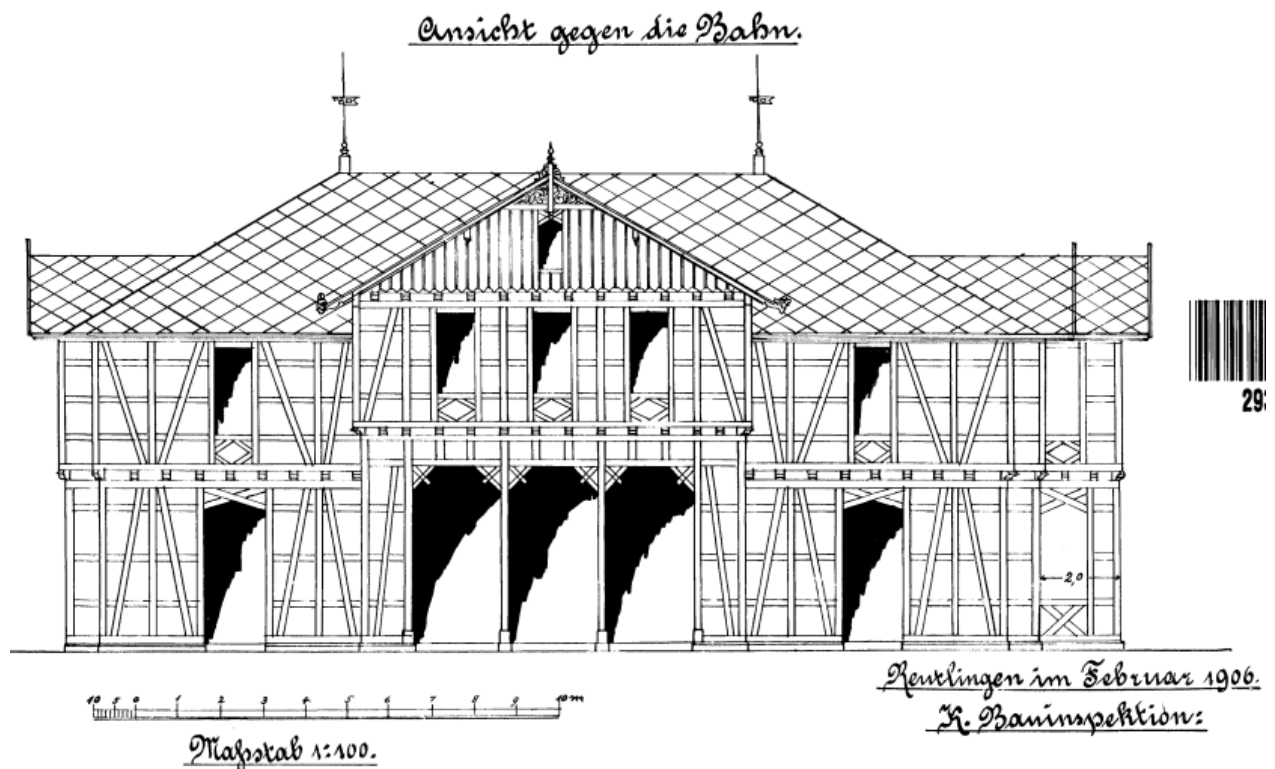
Historischer Plan von 1906 - Fachwerkbau
